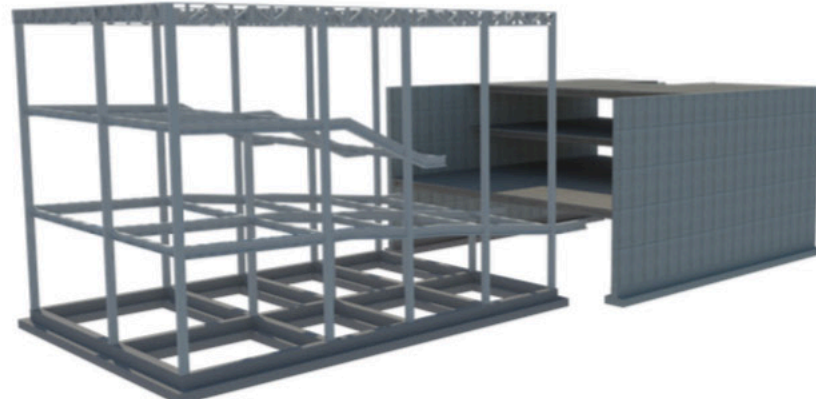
Proceso constructivo - séptima fase: Muro portante, tercer piso
